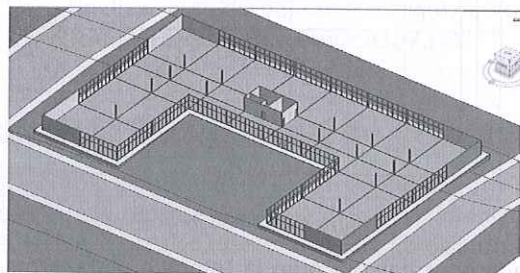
Vista 3D de piso do pavimento Térreo.
